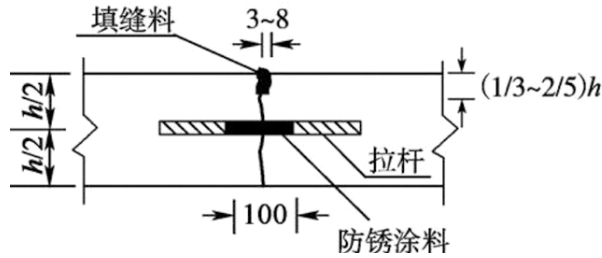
纵向缩缝构造 (尺寸单位: mm)
